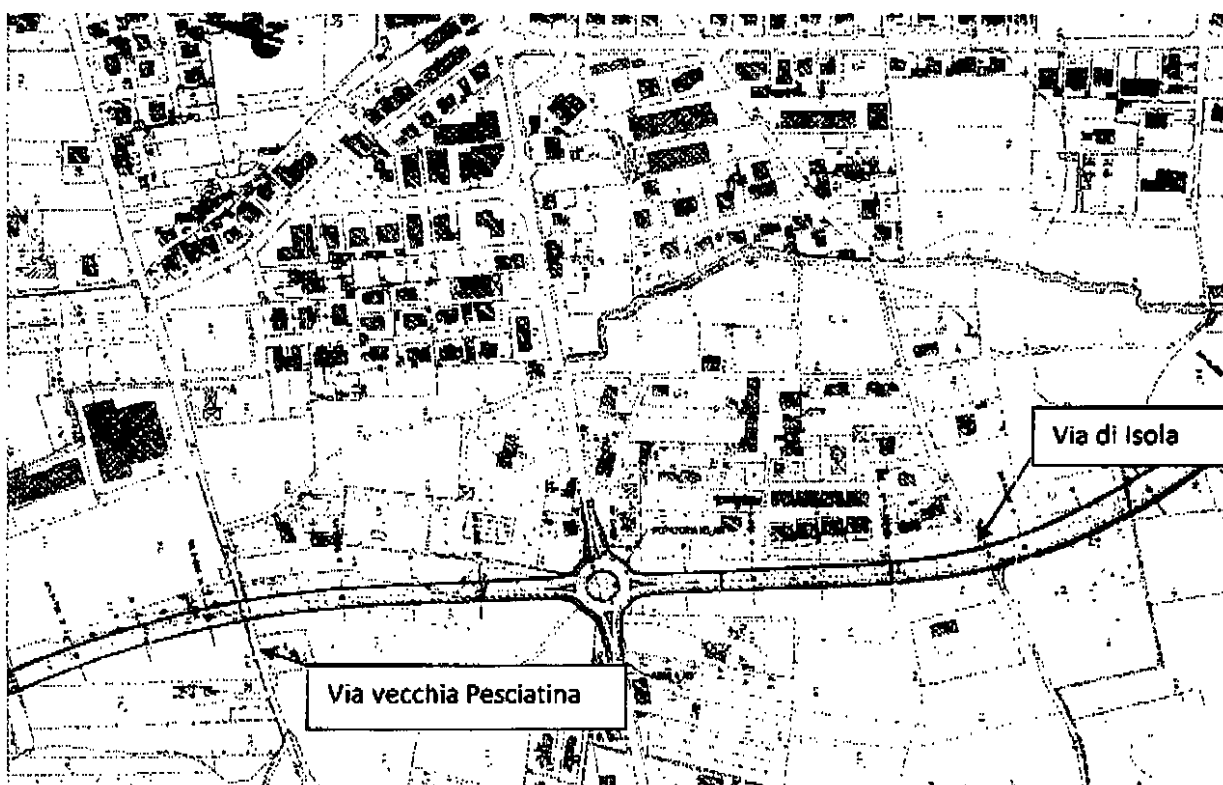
Estratto Tavola T00 PS01 STD PF03 Asse Nord – Sud, Planimetria di Progetto Tav 3/3
